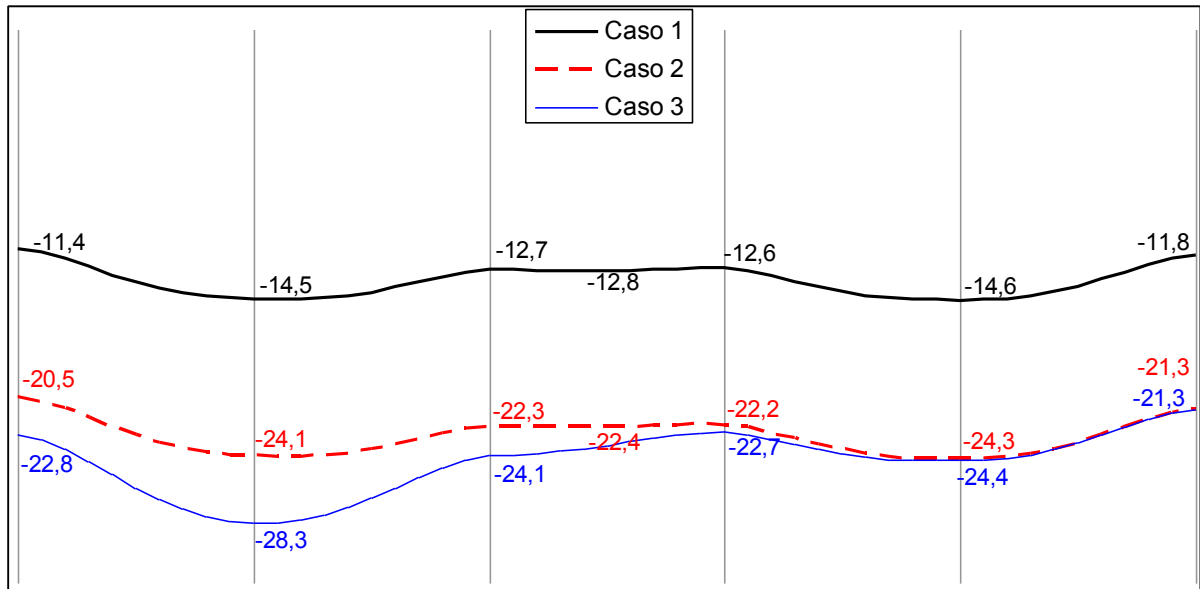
Deformadas em mm– Viga V12 da Cobertura
